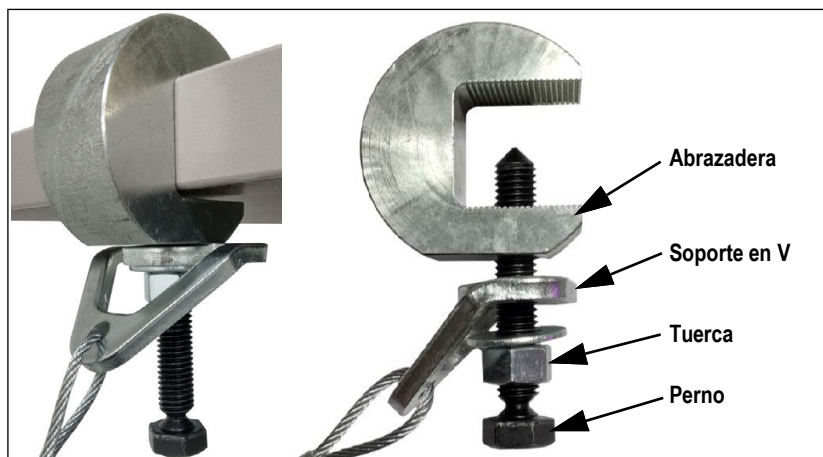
Sujeción sísmica para vigas en estructuras de techo
